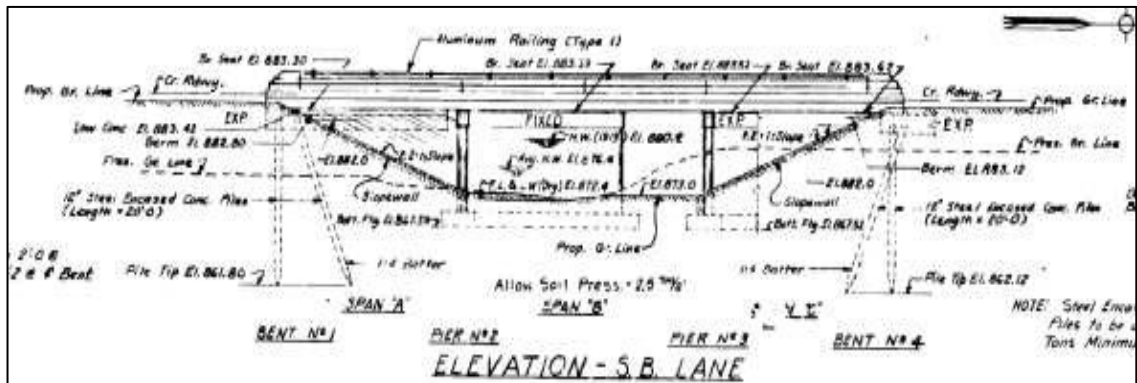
Perfil longitudinal puente No 2 – Planos de diseño
